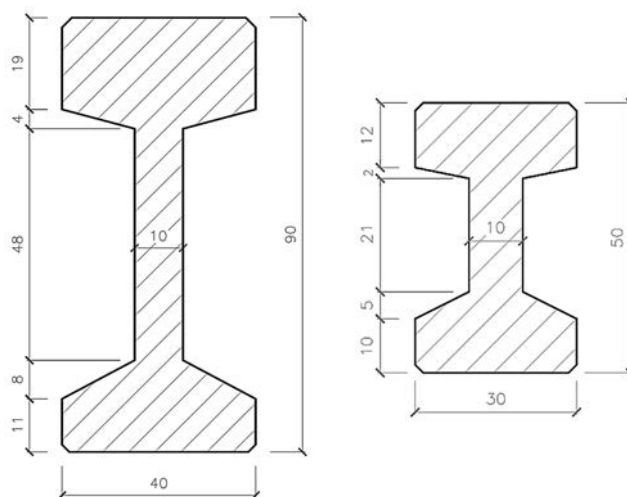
Seções transversais adotadas para as vigas I da cobertura. Fonte: Elaborado pelo Autor
